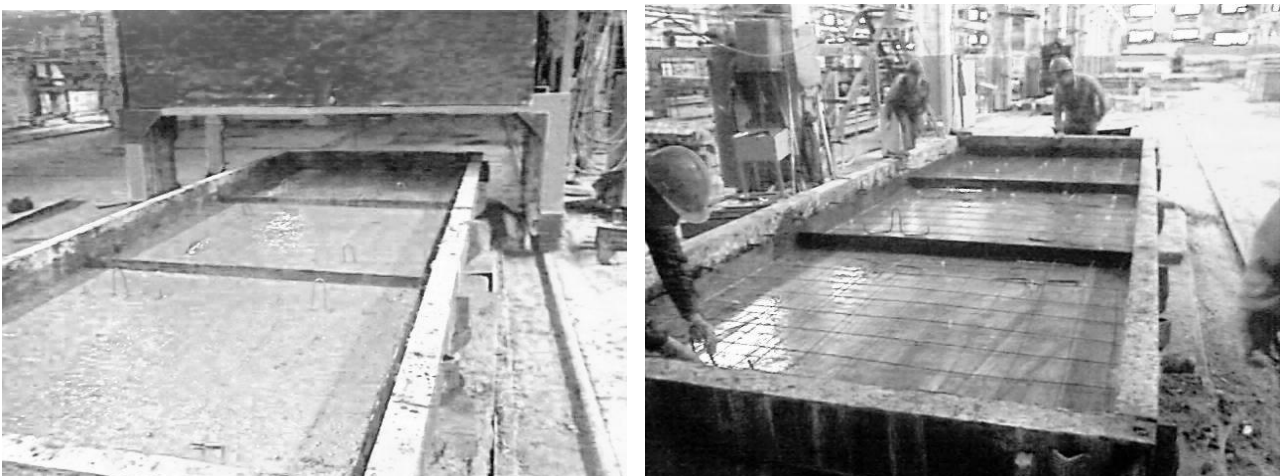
Укладання арматурної сітки та петель. Укладання нижнього шару бетону
